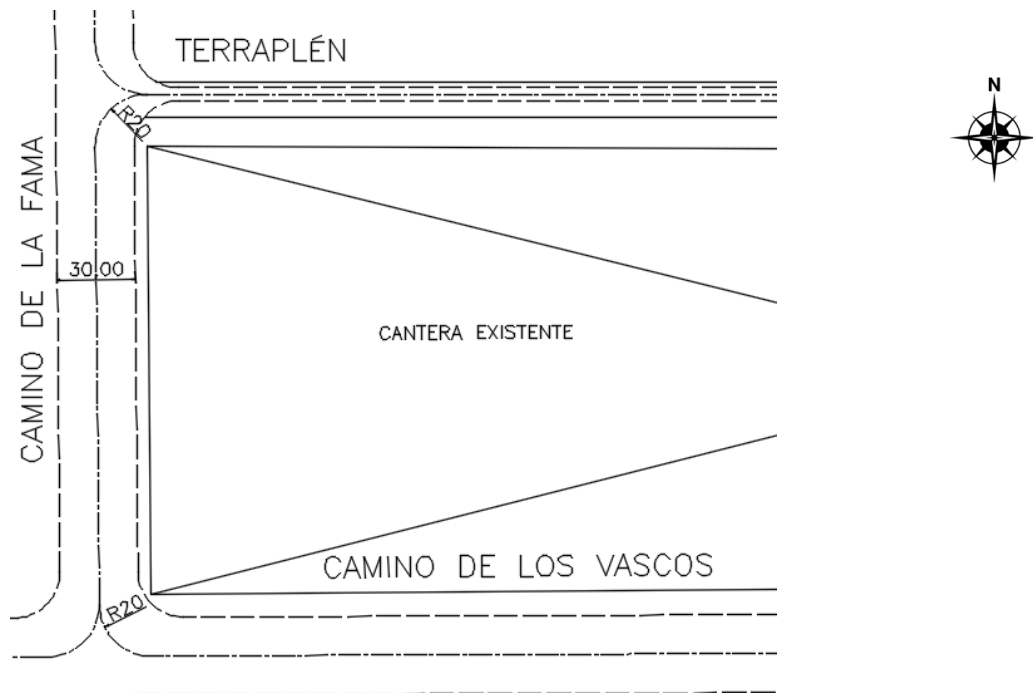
Acceso sur. Planimetría. Fuente: Elaboración propia.
